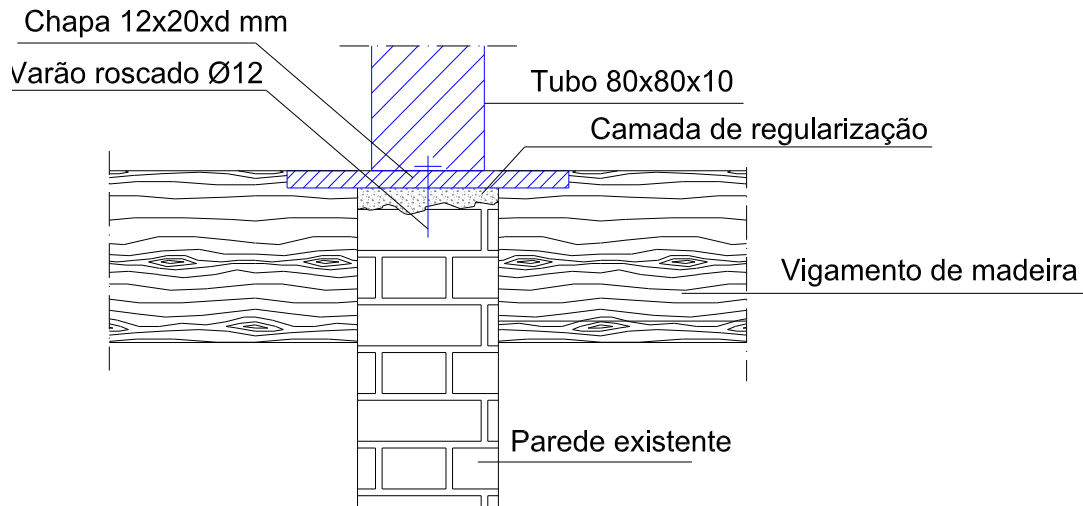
Ligação das chapas de fundação dos pilares à parede resistente (secção)
